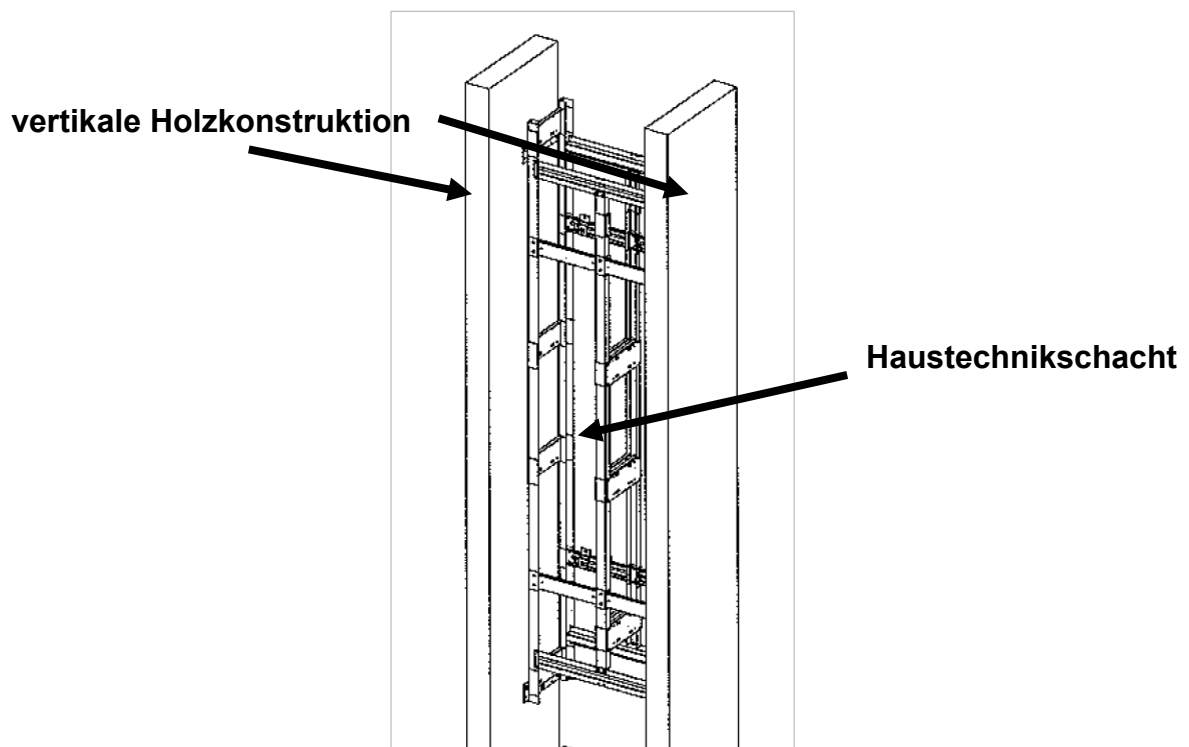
Befestigung des Haustechnikschachtes mittels Holzkonstruktion (Quelle: Geberit Huter GmbH)
